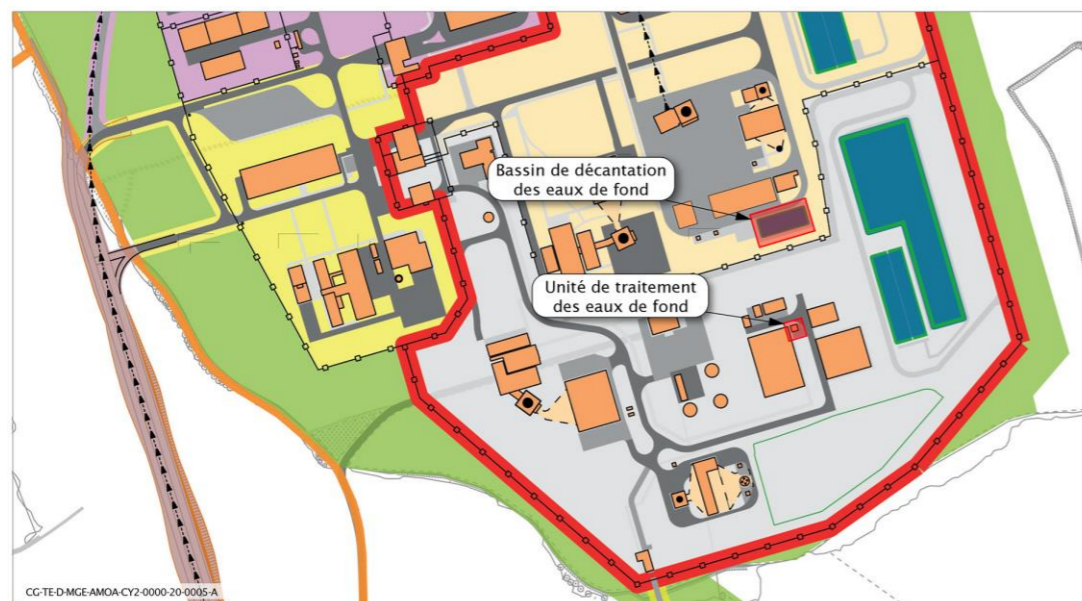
Localisation de la station de traitement des eaux de fond de la zone puits
